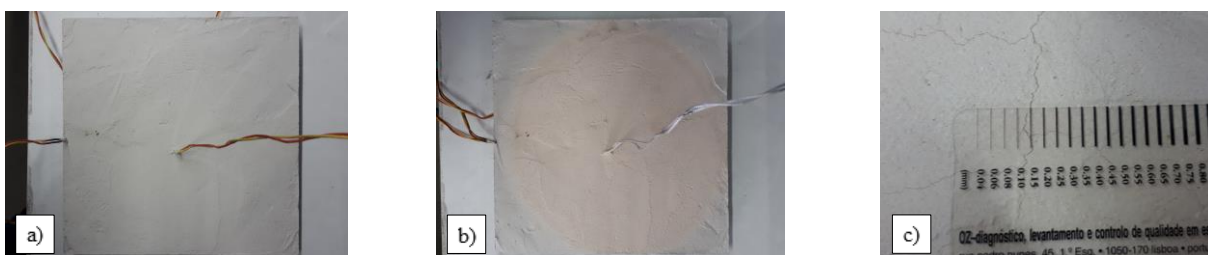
Provete P_A3_3_MI: a) Provete antes do ensaio; b) Provete após o ensaio; c) Fissuração do provete após o ensaio.
